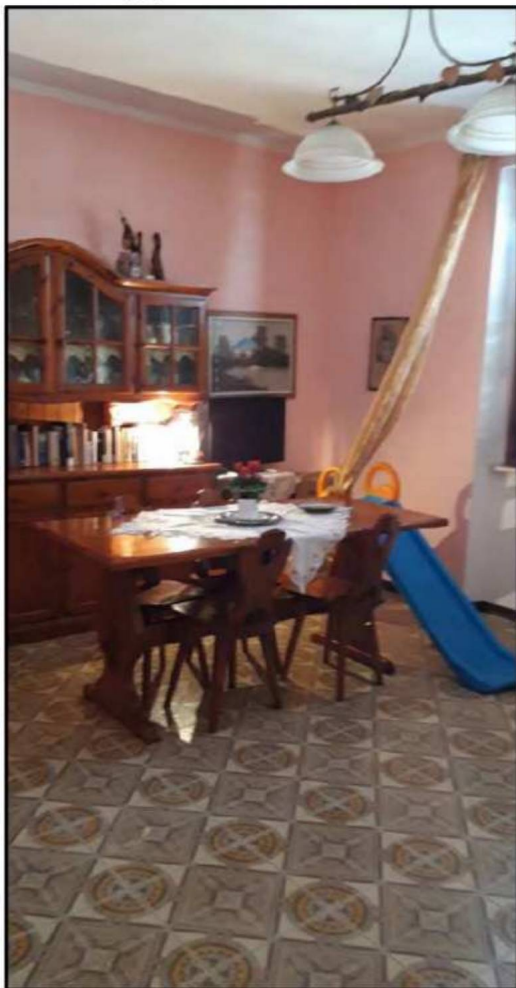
Foto G: Soggiorno particolare: Finestra e porta finestra verso il prospetto principale
